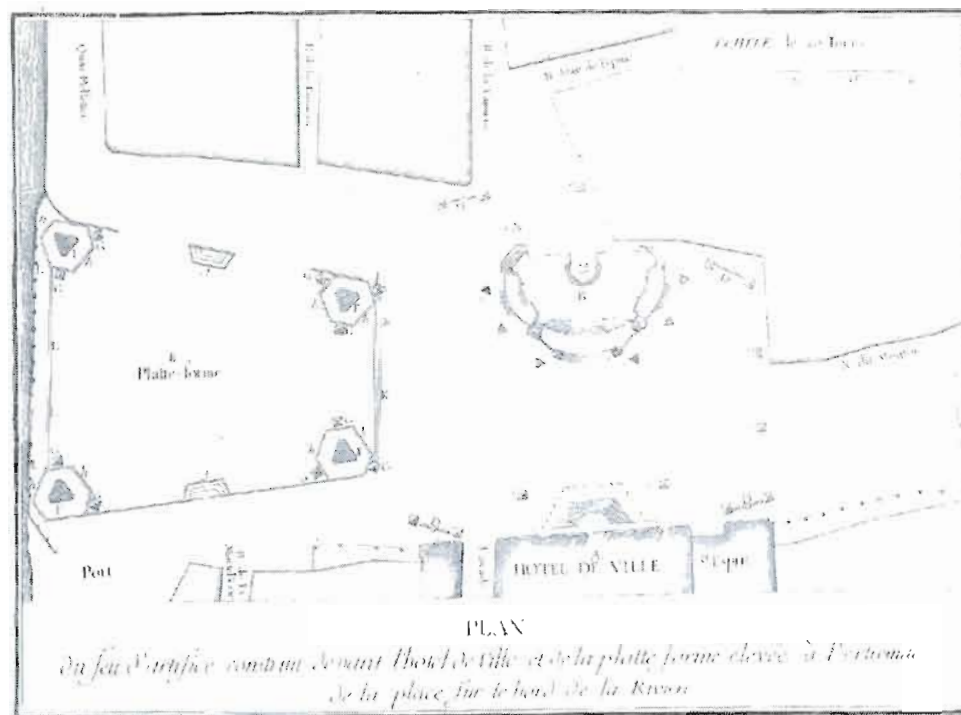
Plan des constructions temporaires dans la place de Grève, février 1749.
